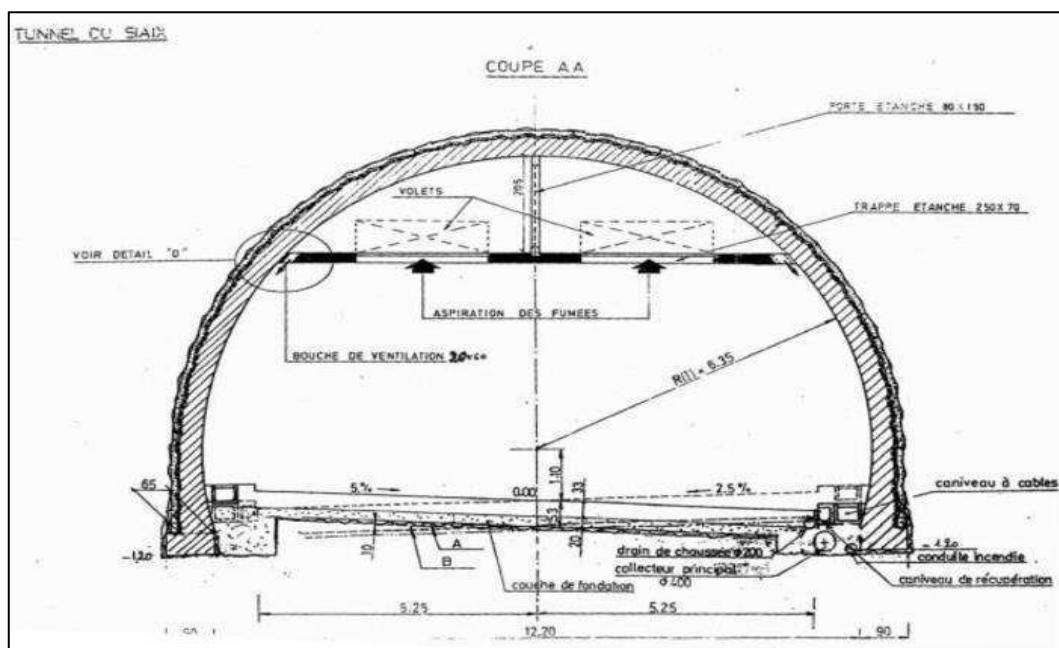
Profil en travers d'un tunnel en forme voûte
